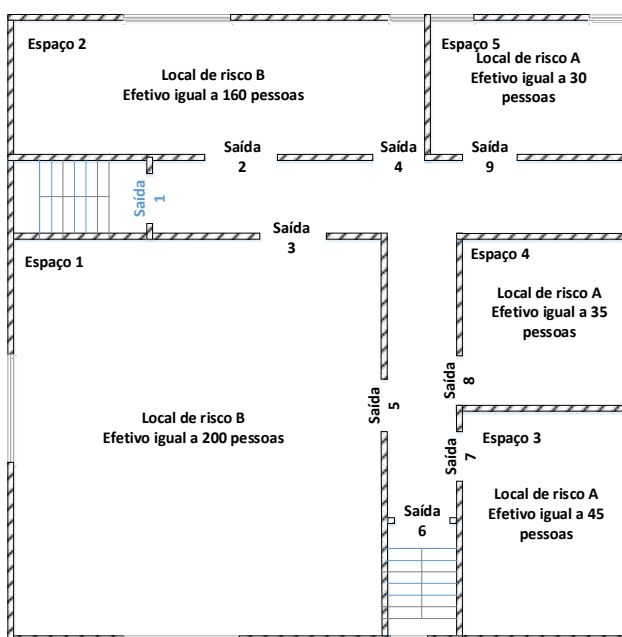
Planta esquemática de um piso sujeito a intervenção
